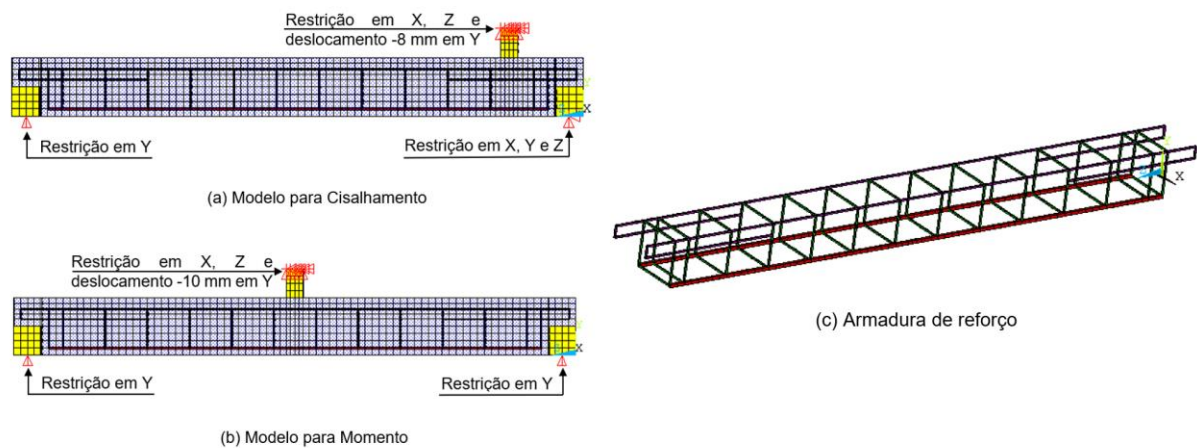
Detalhamento da armadura e geometria da placa de concreto
